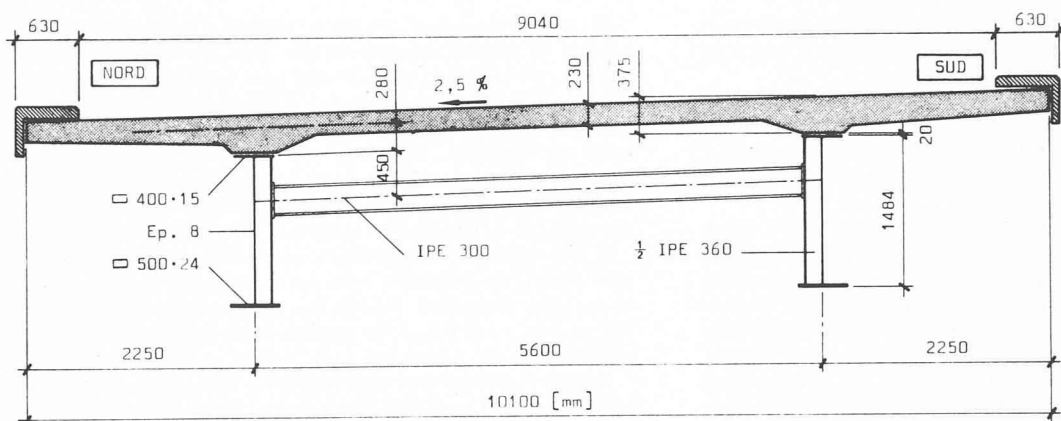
Section transversale en travée, au droit d'une entretoise.
